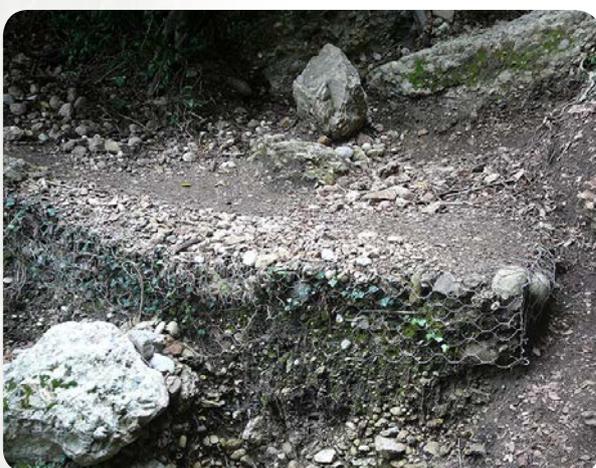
Dique de retención. Tipo de sillar construido con piedras rodeadas por una red de alambre. Pueden constituir una buena alternativa para proteger los caminos en puntos especialmente débiles. Foto: Joan Llovet.
